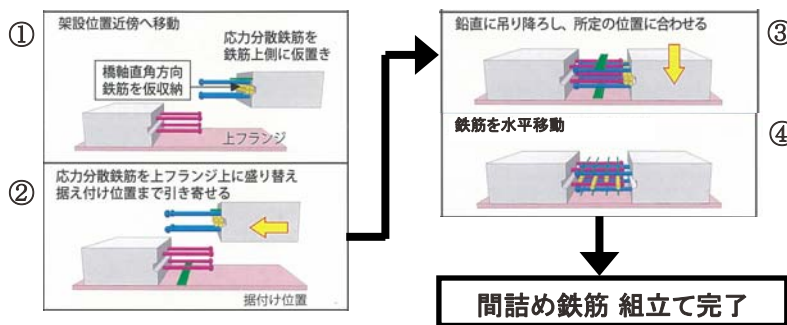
床版架設と間詰め鉄筋組立ての施工ステップ図
